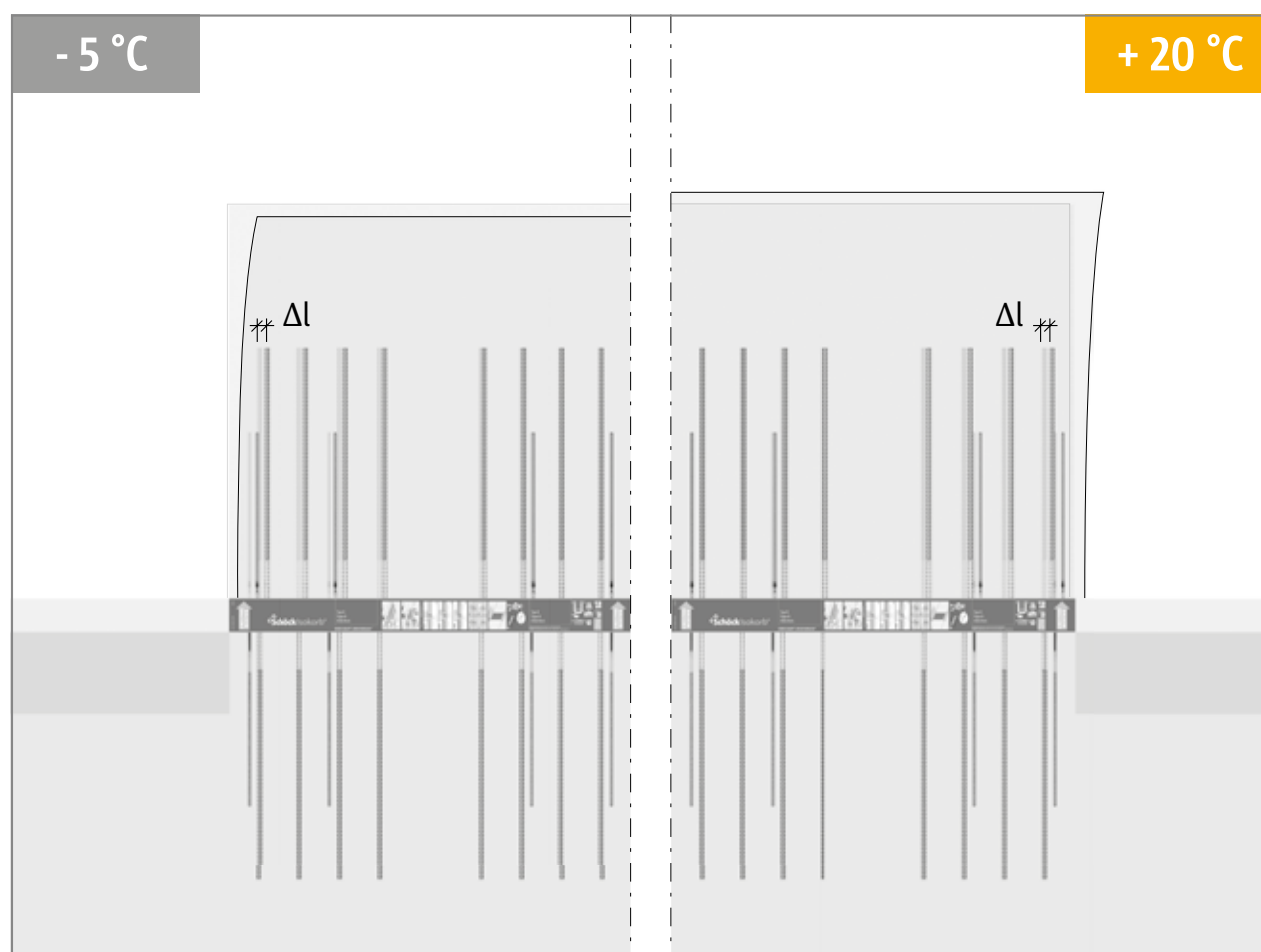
Schöck Isokorb®, deformazione dovuta a carico termico
